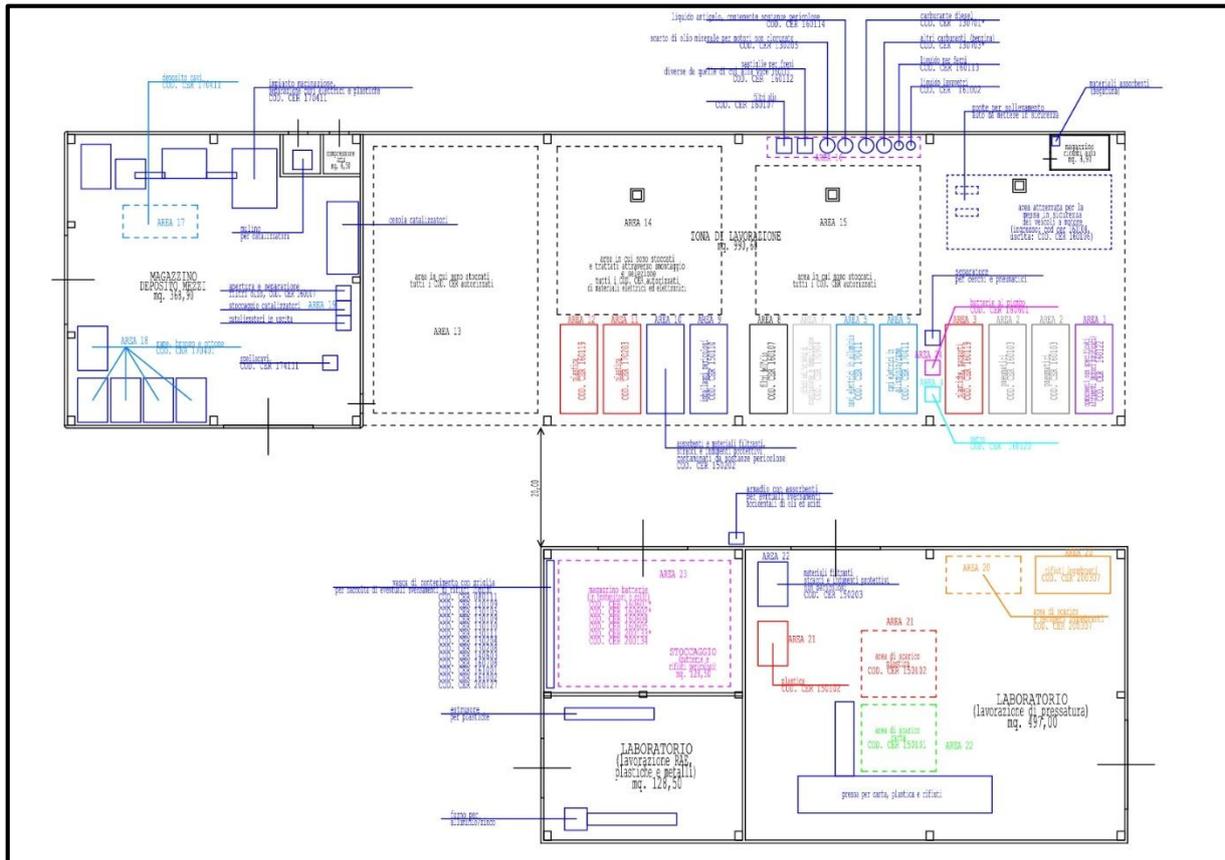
Planimetria di dettaglio stoccaggi interni ai capannoni (Tav. A1)
